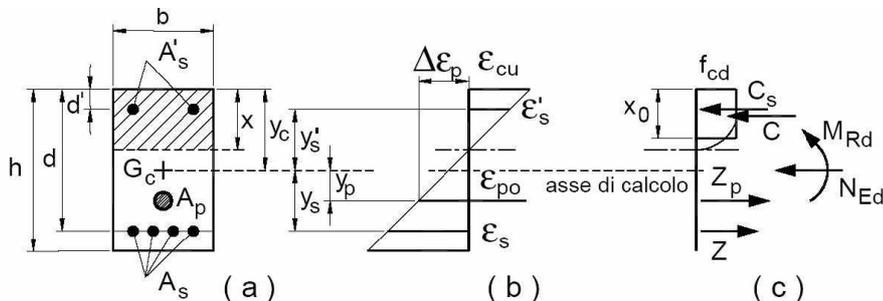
Sezione pressoinflessa (equilibrio delle forze interne corrispondenti al raggiungimento della deformazione ultima nel calcestruzzo)
